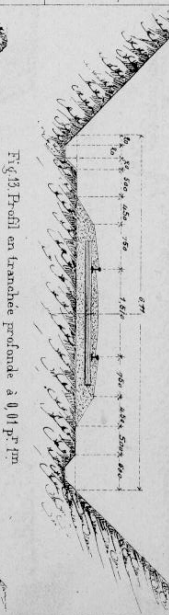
Profil en tranchée profonde à 0,04 p. 1 m.
